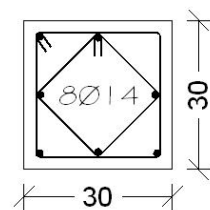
Coupe transversale d'un poteau type en béton armé.
